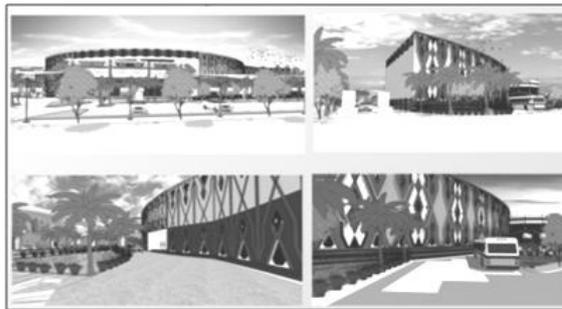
Ruang Luar dan Elemen Ruang Luar
